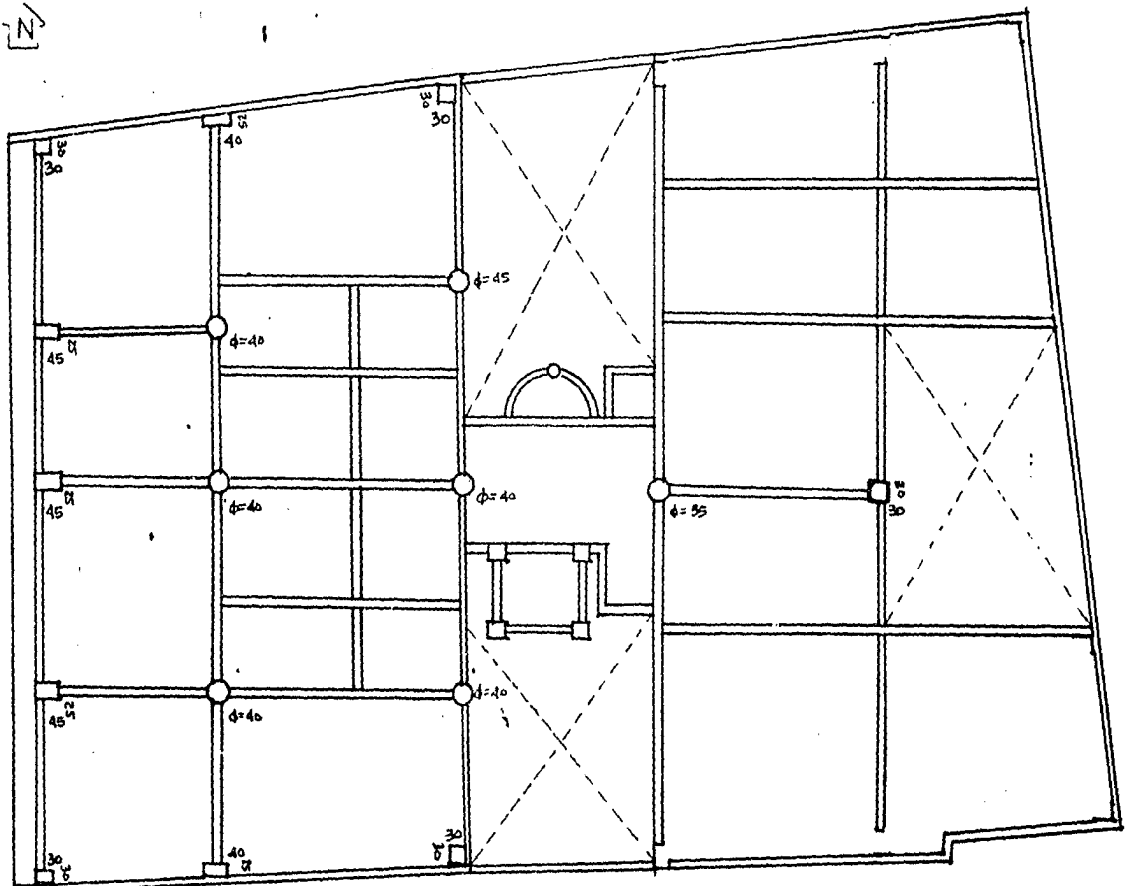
e Dimensiones de columnas (cm) nivel 8
